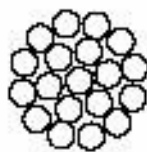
Sezione cavo di supporto della rete di alimentazione ferroviaria
